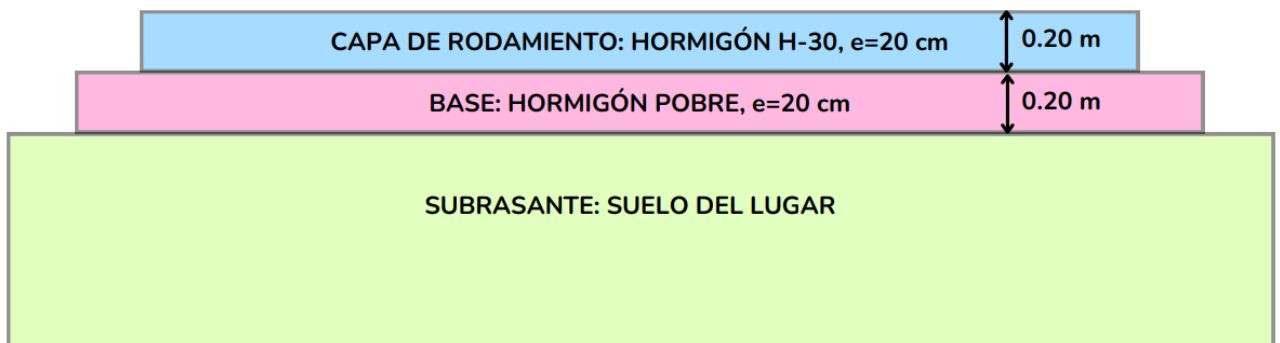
Paquete estructural del pavimento. Fuente: Elaboración propia.
